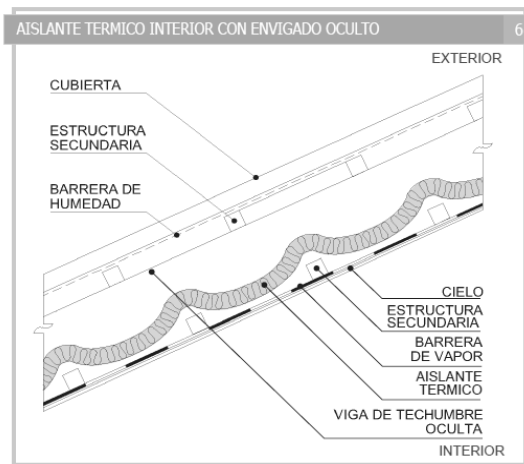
Techumbre con vigas de madera con aislamiento térmico (MINVU, 2006).
